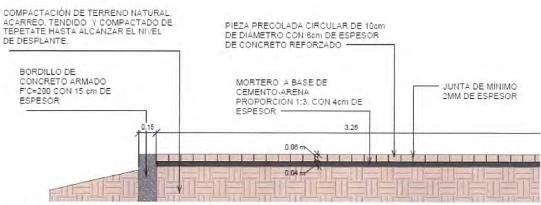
Detalle tipo transversal de sistema de piso en desembarques en junta con guarnición.
